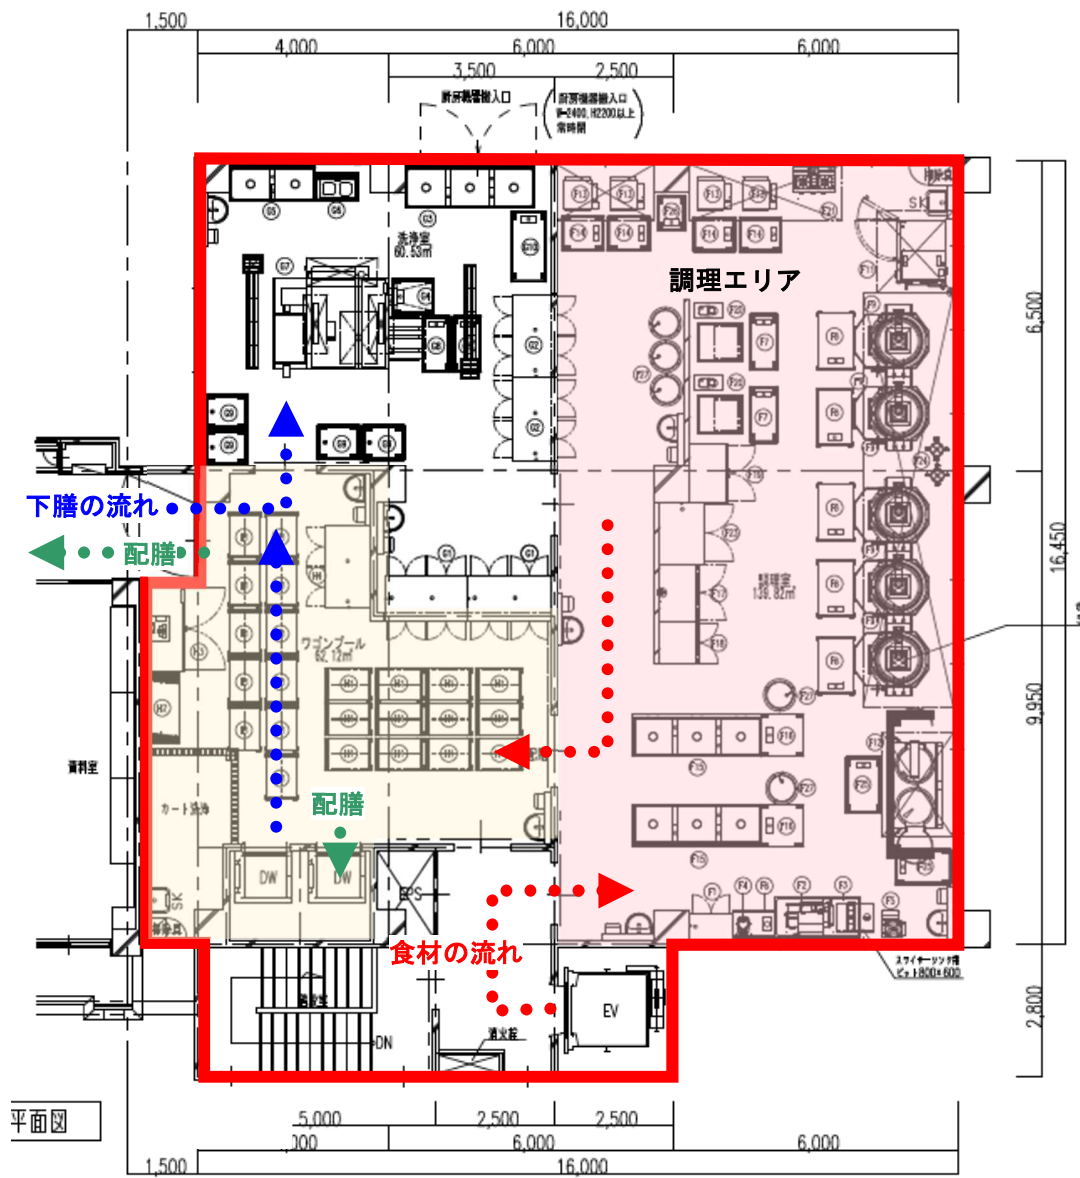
事例②計画食数 600 (食/日) 給食室 2階平面図 (302 m<sup>2</sup>)
